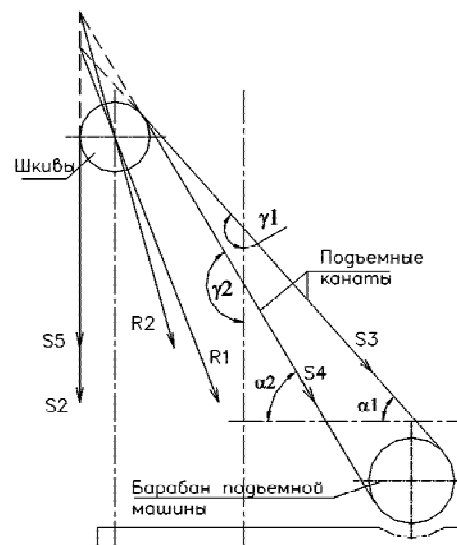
Схема передачи нагрузок от натяжения подъемных канатов на конструкции укосных шахтных копров.
